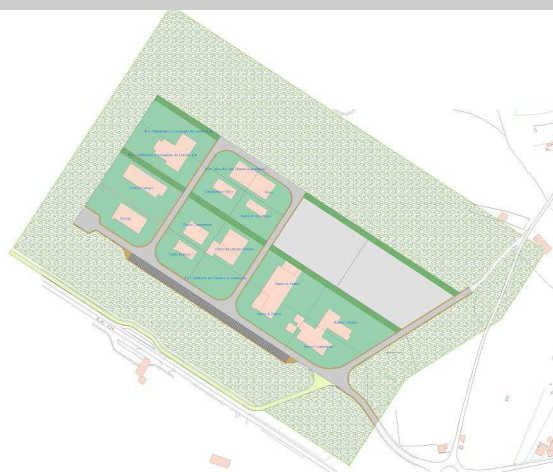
Planta de implantação do PP da Zona Industrial de Febres
